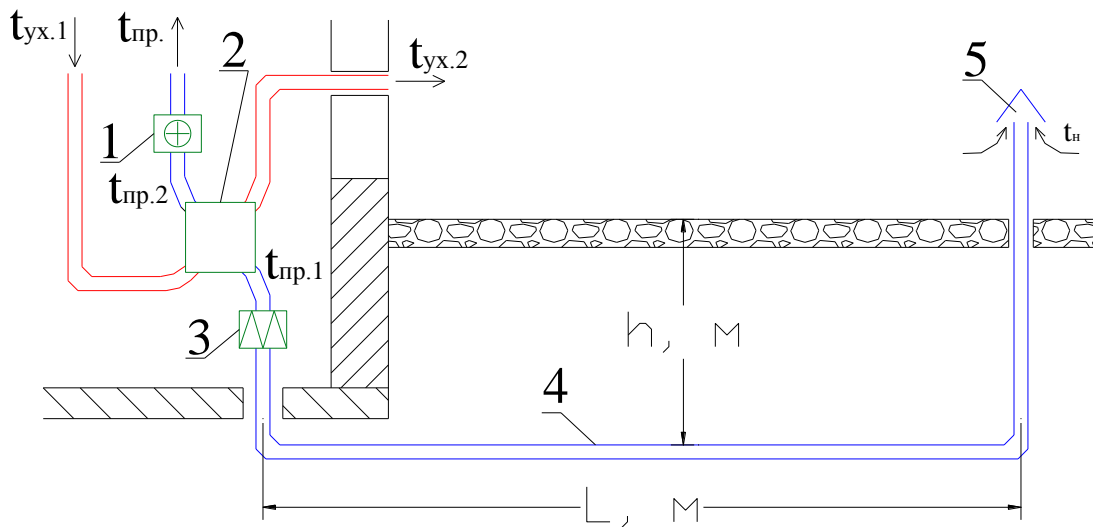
Принципиальная схема вентиляции здания с утилизацией теплоты грунта и вытяжного воздуха:
